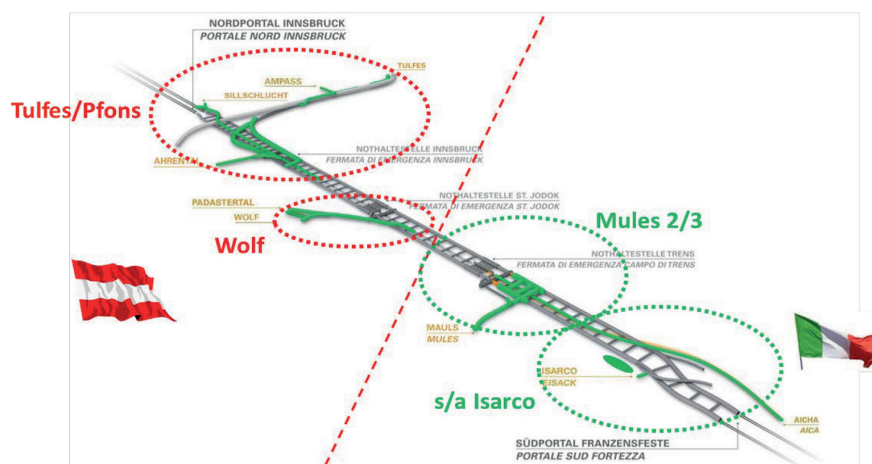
I cantieri attivi del Tunnel di Base del Brennero.
